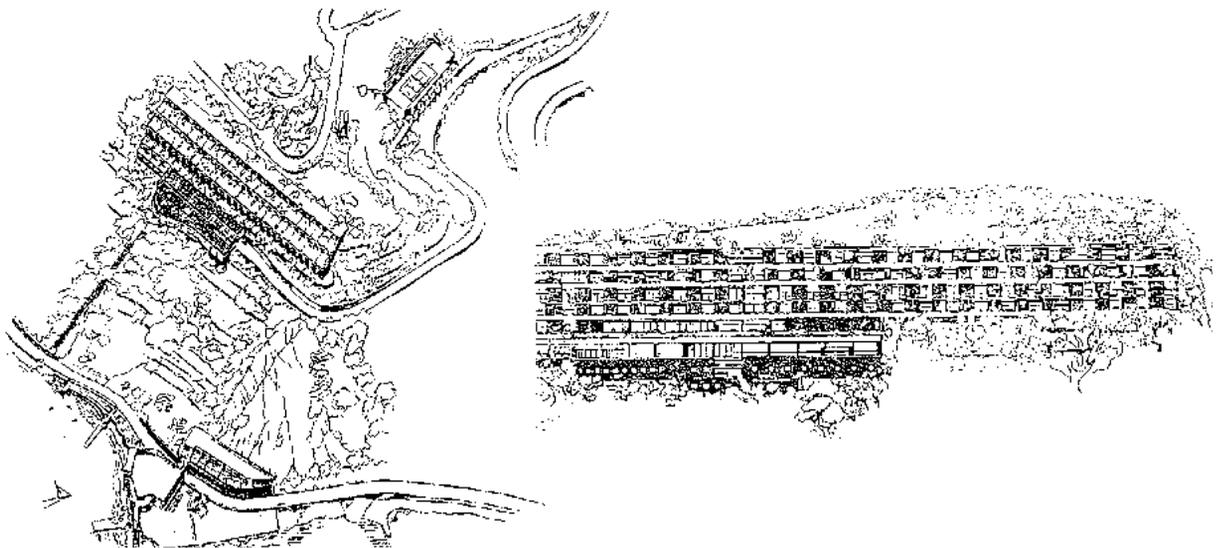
Luigi Vietti. Prospettiva e prospetto dell'albergo Nord-Est (1937).
